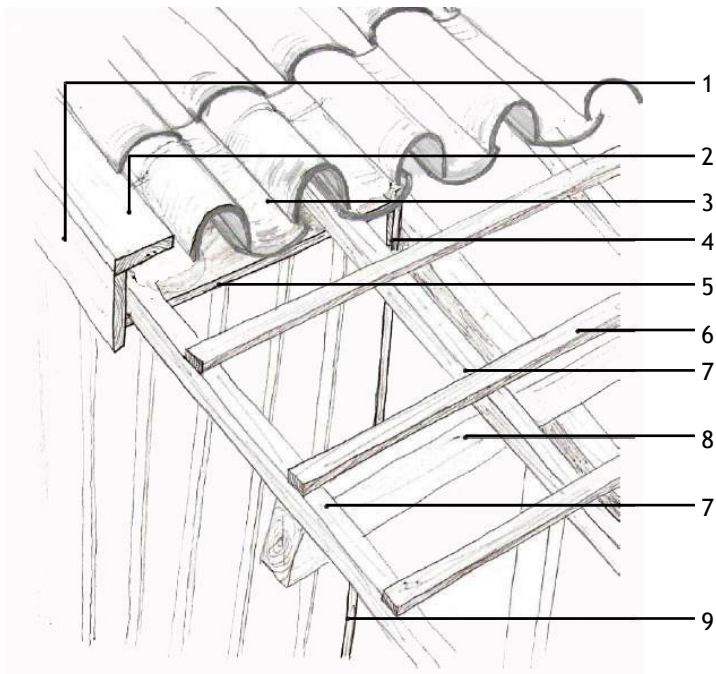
Desenho de pormenor de um beiral de fachada principal. [5]
